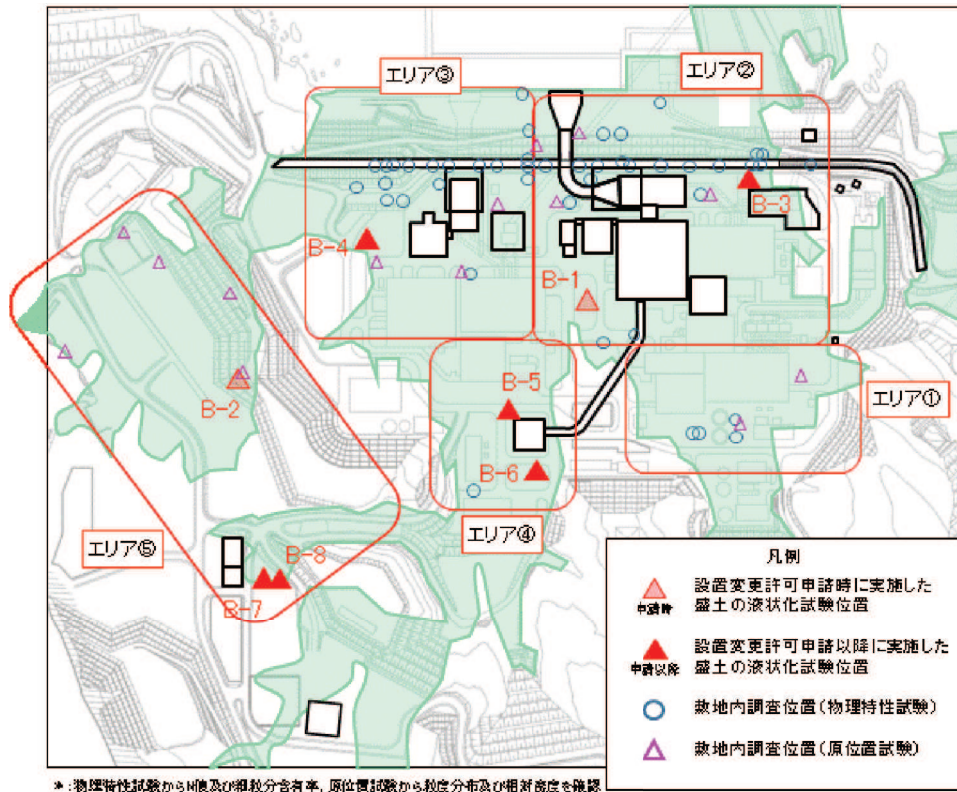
盛土の液状化強度試験位置及び敷地内調査位置の平面図
